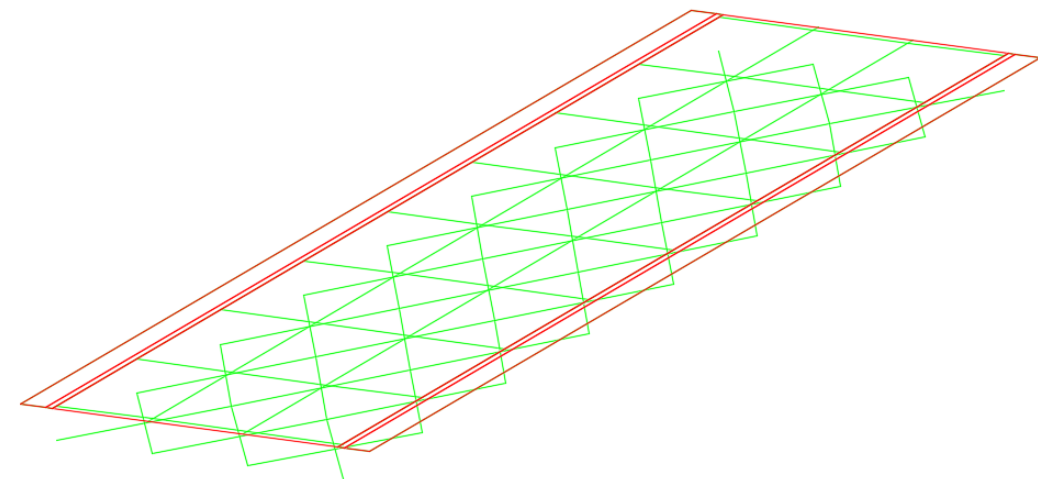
Vista 3D de plano para SAP2000. Elaboración propia con AutoCad.
